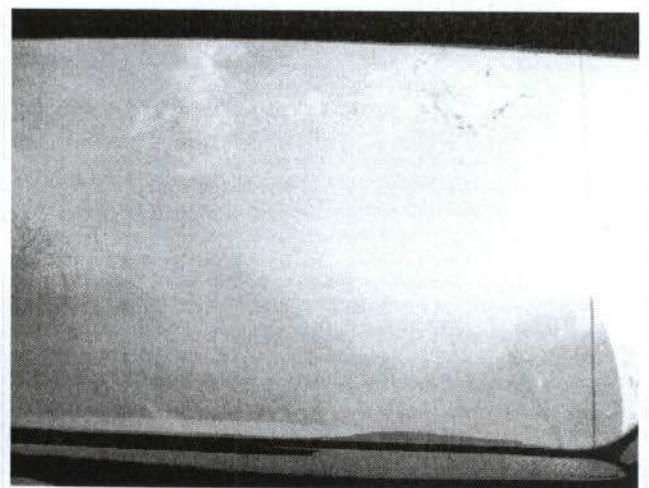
Levante de poeira na via de acesso entre a jazida de brita e o canteiro industrial devido à falta de umectação
